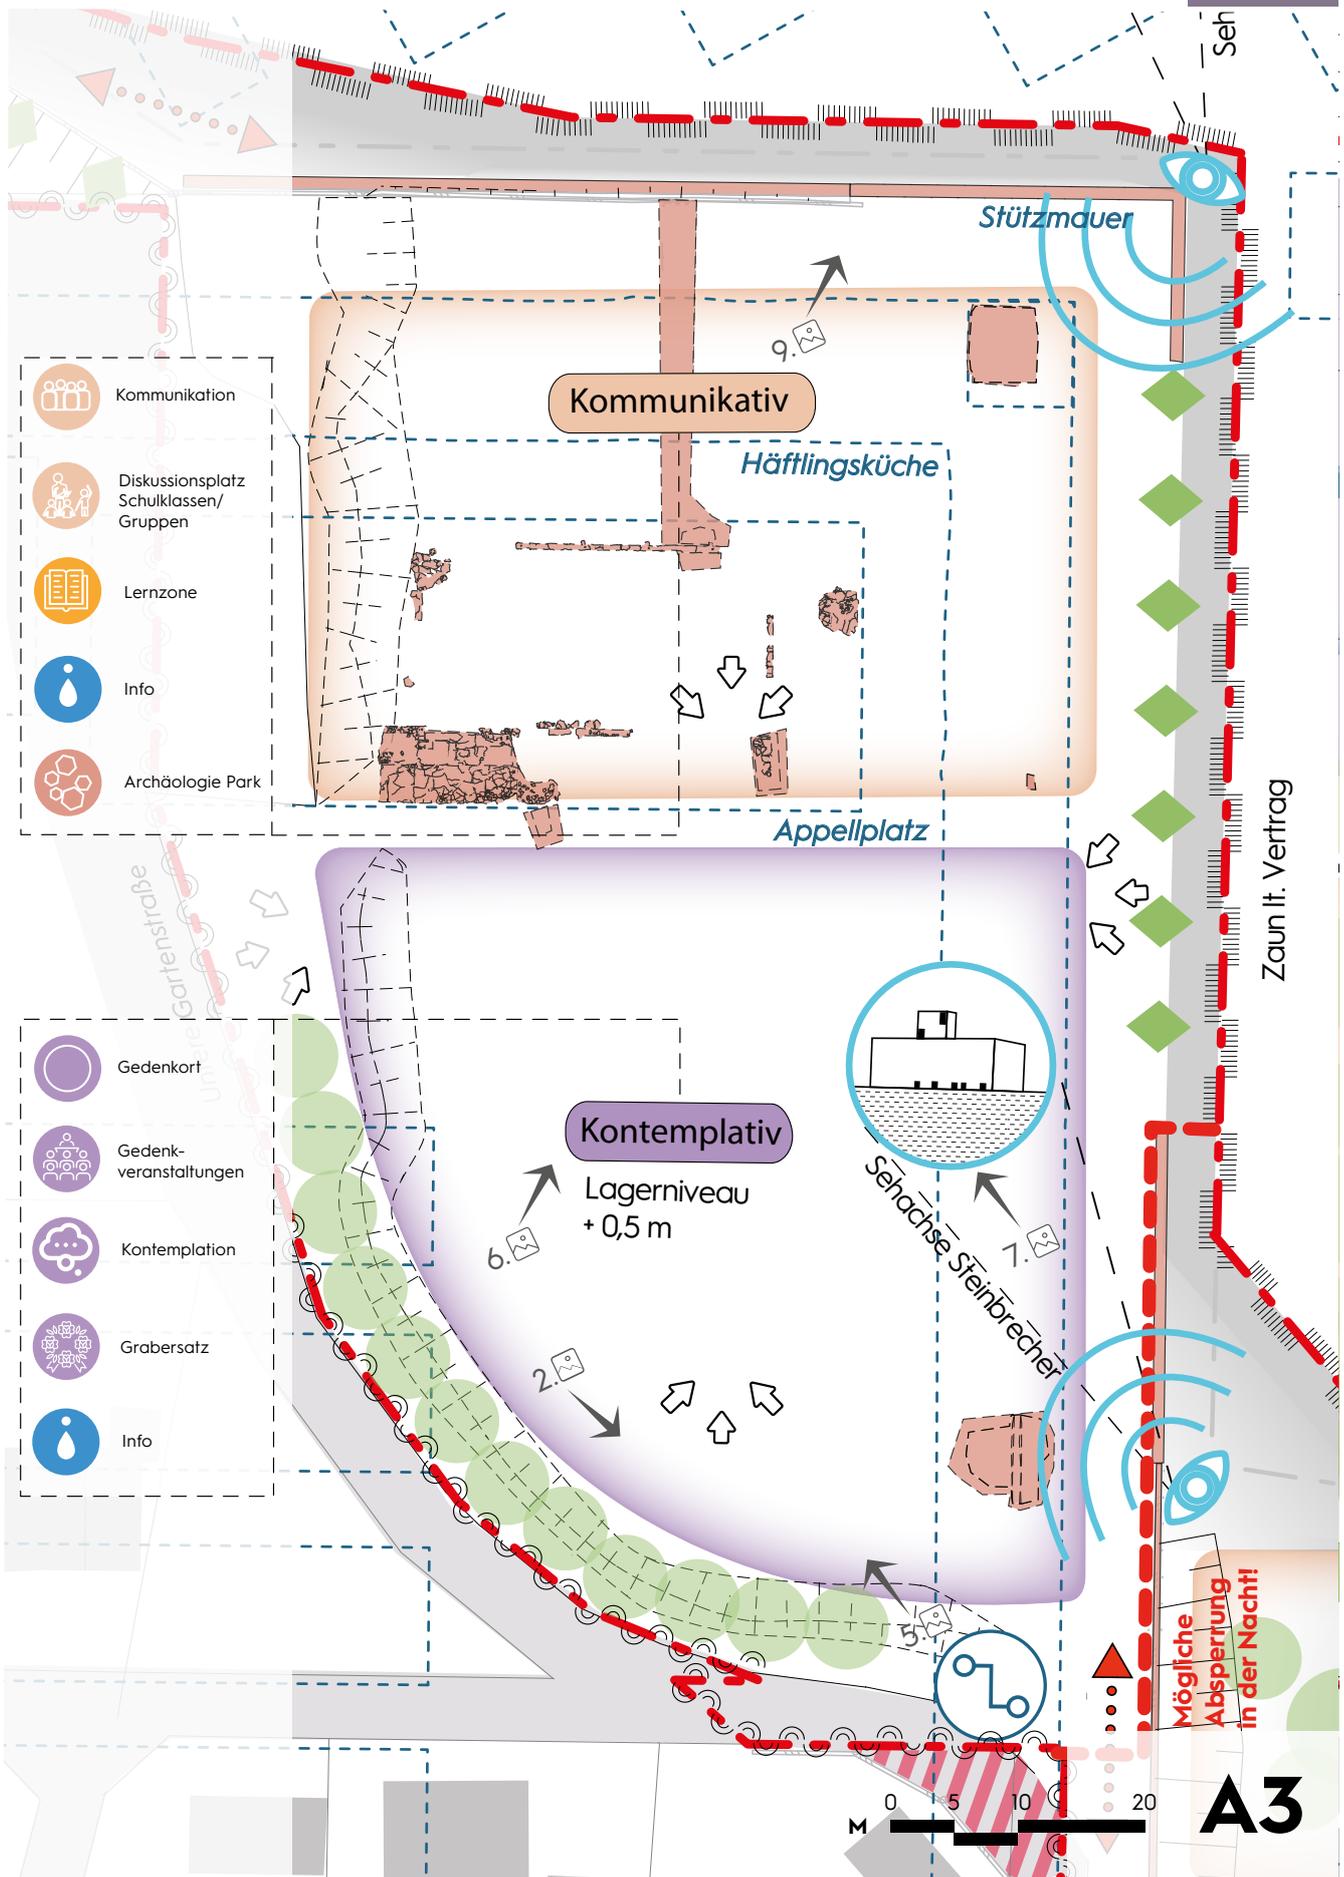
Masterplan Grundriss Appellplatz (Ausschnitt A3)
